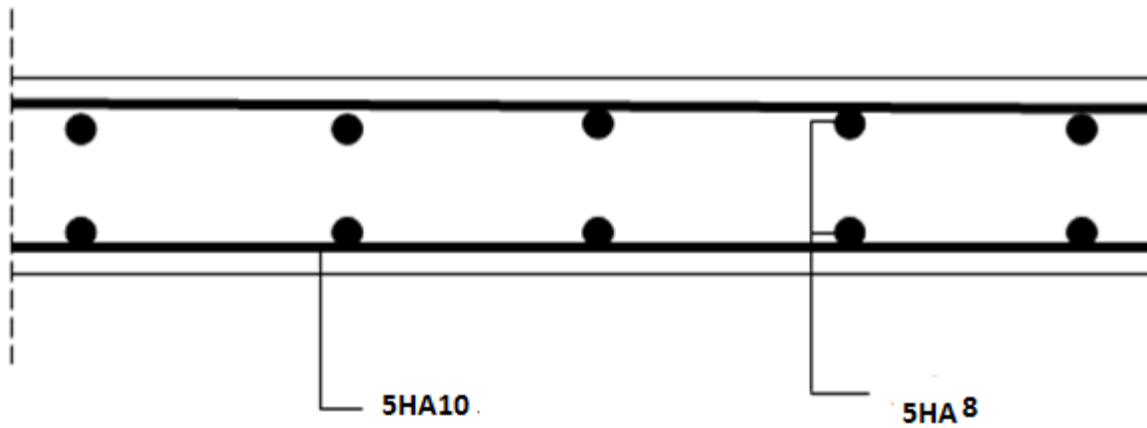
Plan de ferraillage de la salle machine suivant x-x.
